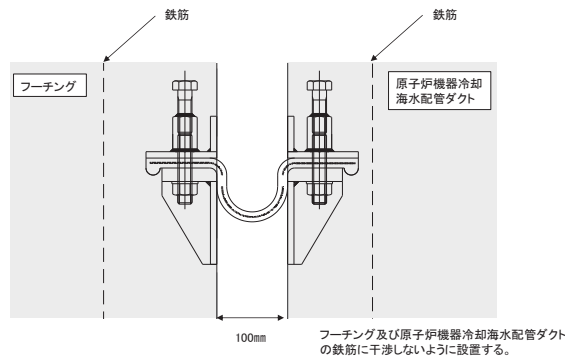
(3) 止水パターン③の止水ジョイント構造概要(Ω型ジョイント施工イメージ)
